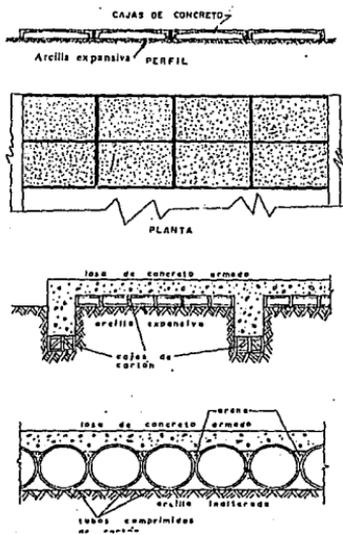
, 5.14, 5.15 Cimentaciones en arcillas expansivas
